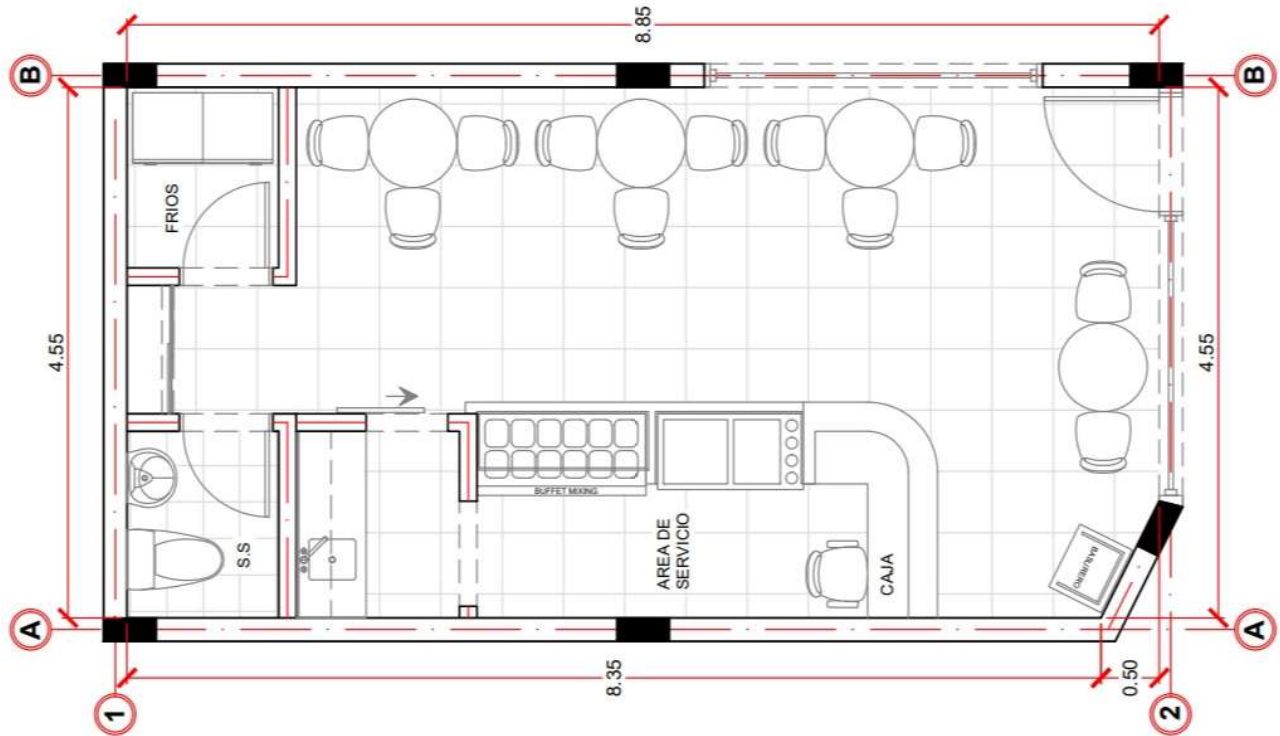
Planta arquitectónica anteproyecto de Roll•Ahoic.
